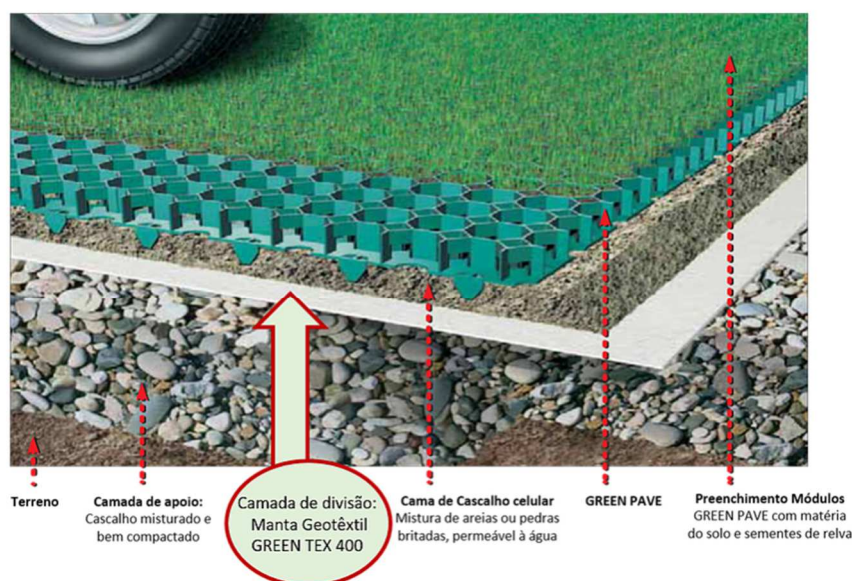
Estrutura de pavimento com grelhas de arrelvamento – exemplo 1 (<https://www.urbangreen.pt>).
